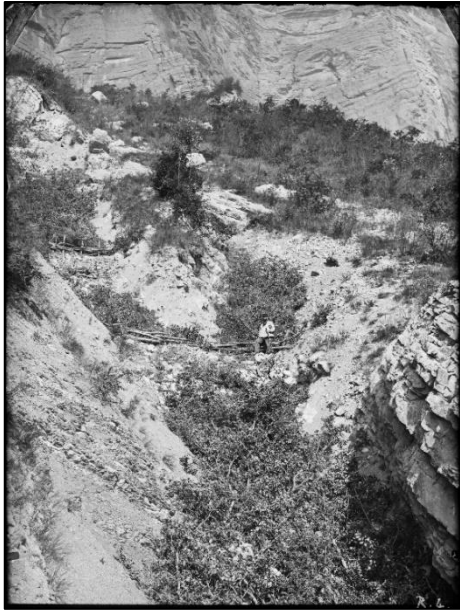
Travaux de façonnage de lit dans les ravins, torrent de la Ruine (Isère, octobre 1888, photo prise par Charlemagne).
